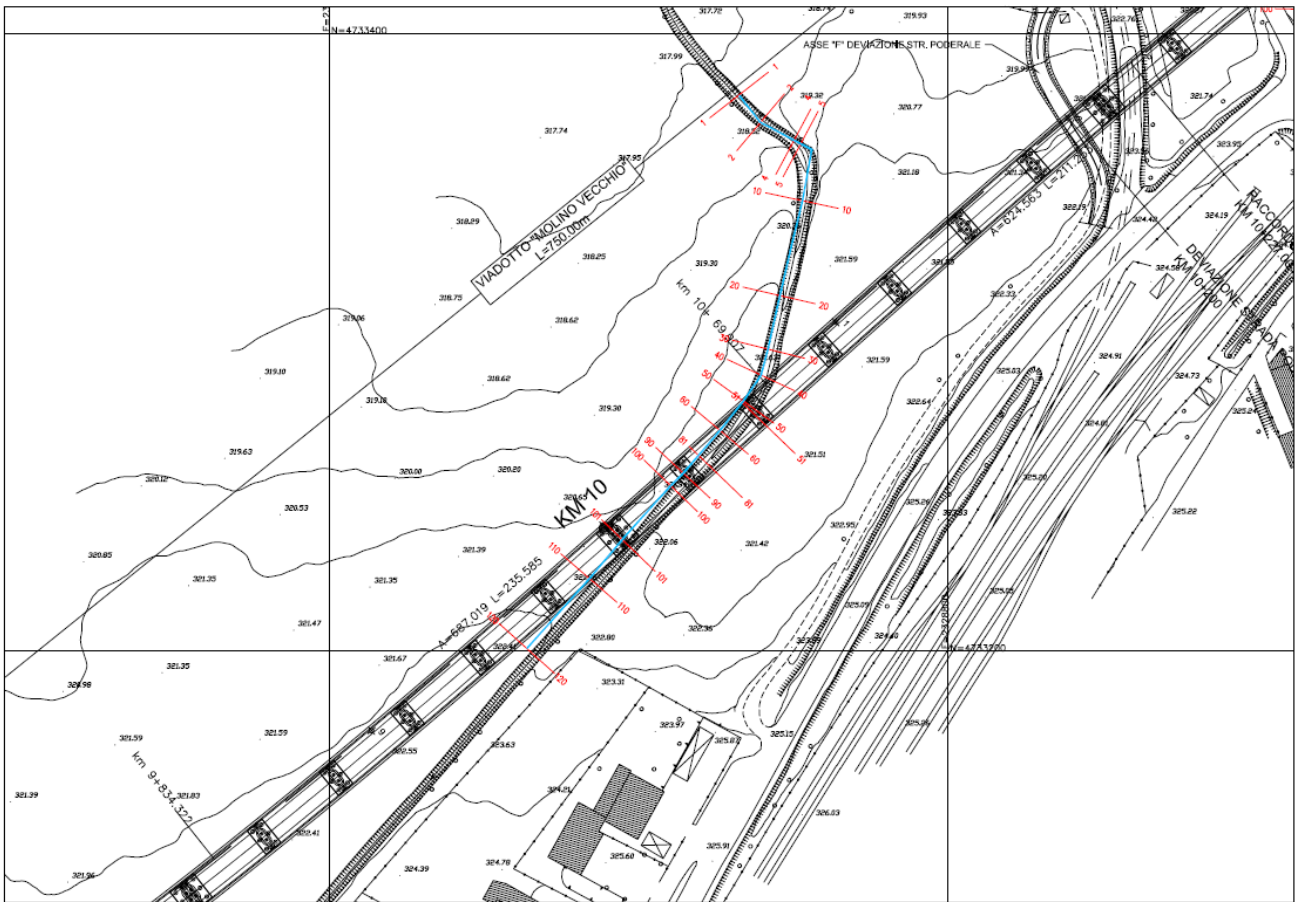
Planimetria dell'intervento e sezioni trasversali d'alveo Canale Molino II.
